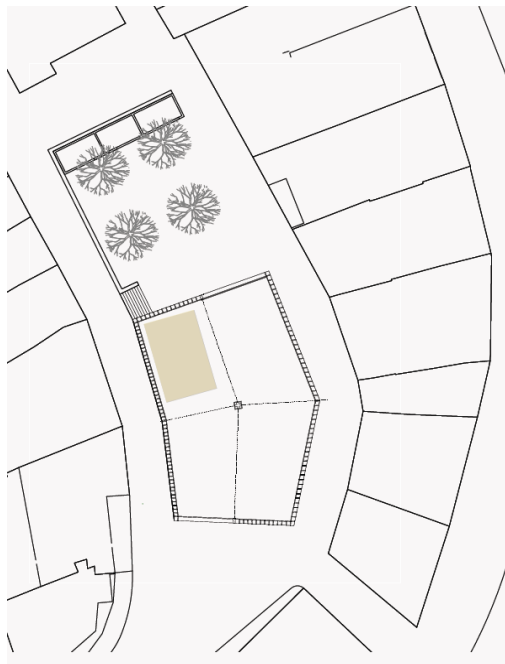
Gedämmter Halleneinbau (ca. 60m²)
